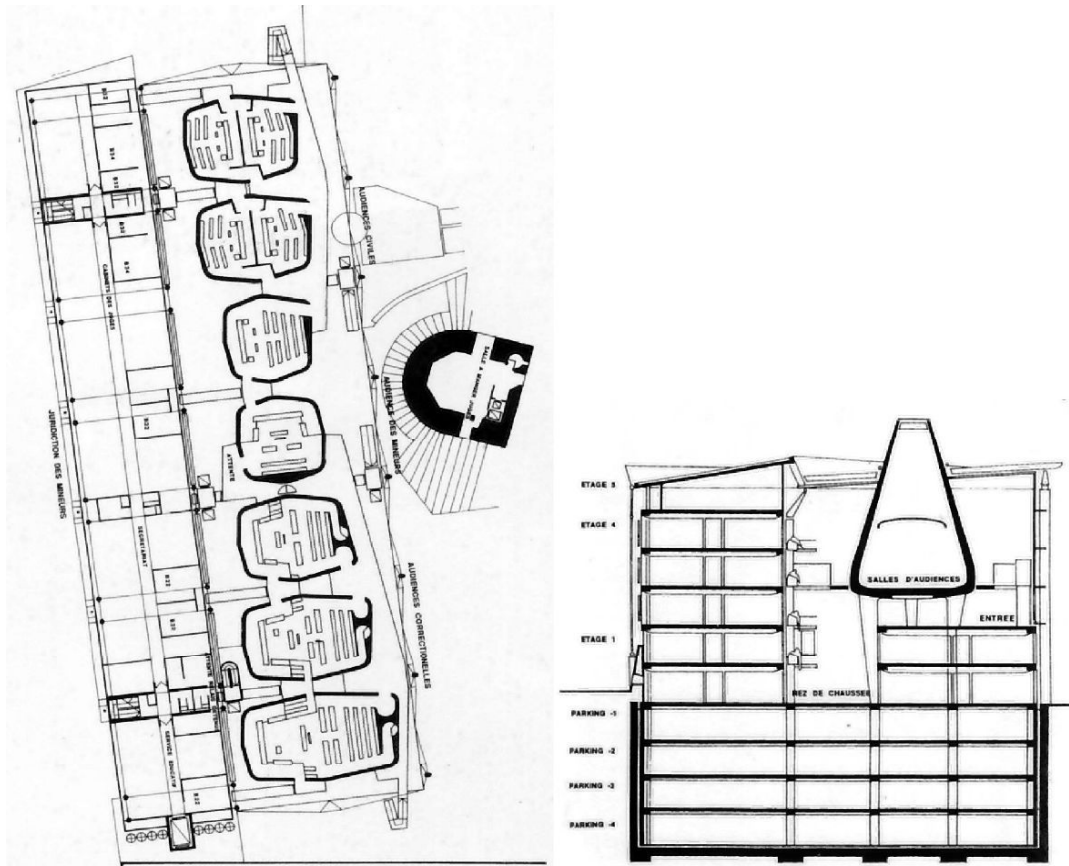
Planche de concours : plan au niveau des salles d'audience (Nord vers le haut de l'image) et coupe transversale sur les bureaux et sur les salles d'audience
